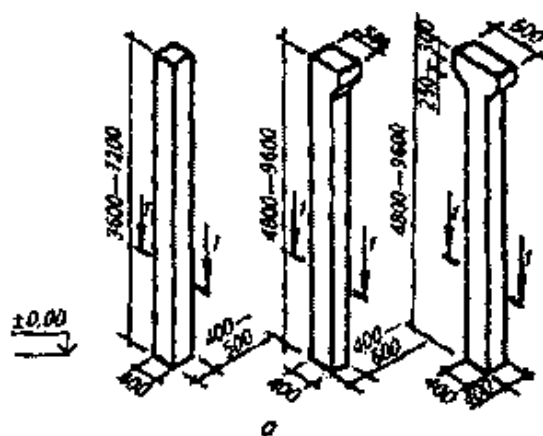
Основные типы железобетонных колонн для одноэтажных зданий:
